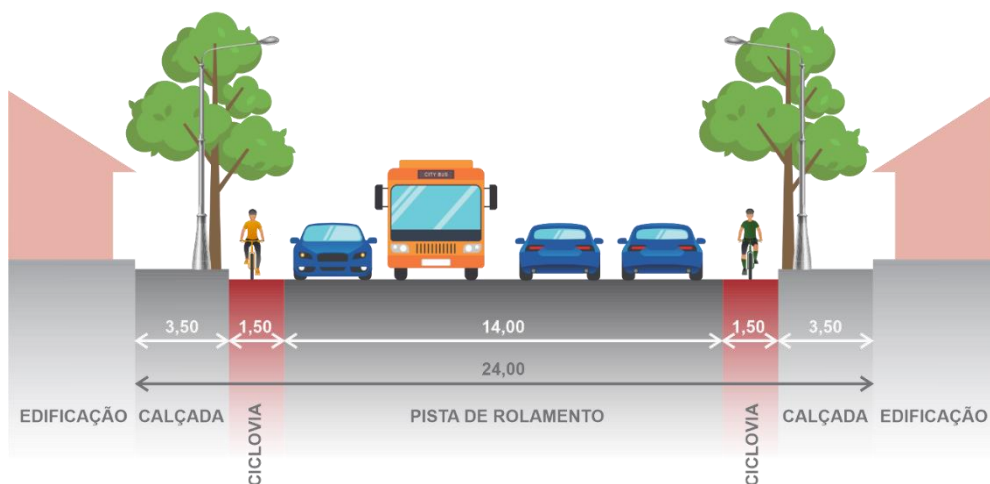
Via de Trânsito Rápido: estrutura e dimensões
